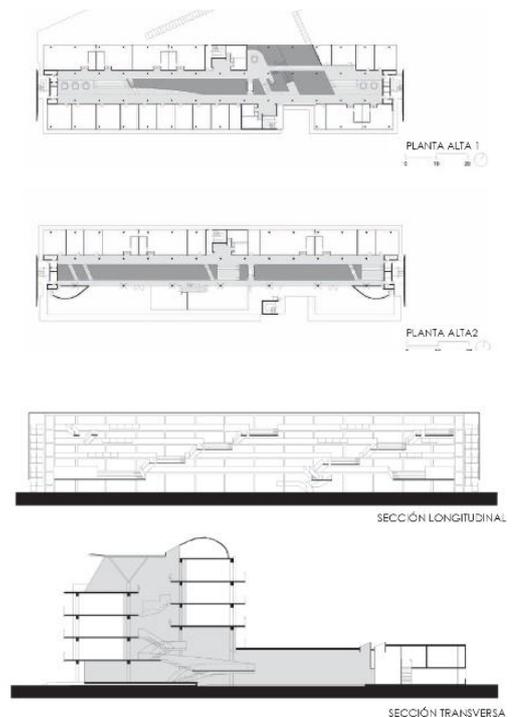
Planimetría Montessori College Oost. Elaboración propia.
